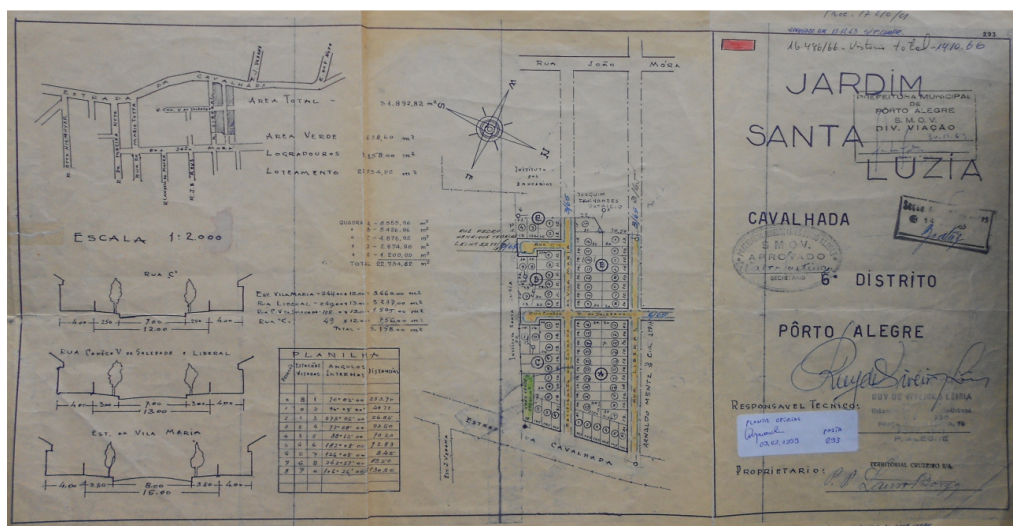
Planta do Loteamento Jardim Santa Luzia. Projeto do Engº Ruy de Viveiros Leiria, 1963.
